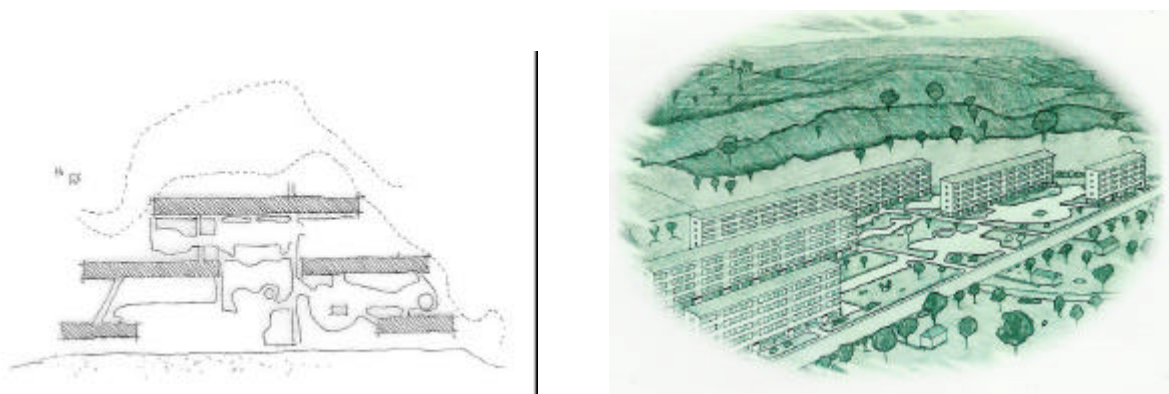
Planta de situação e perspectiva do projeto original do Conjunto Residencial Salvador (1948).
